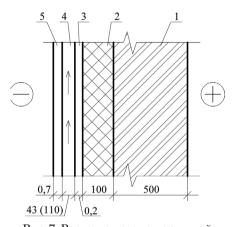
Расчетная схема наружной стены сушильного отделения Fig. 7. Design diagram of the outside wall of the drying compartment
